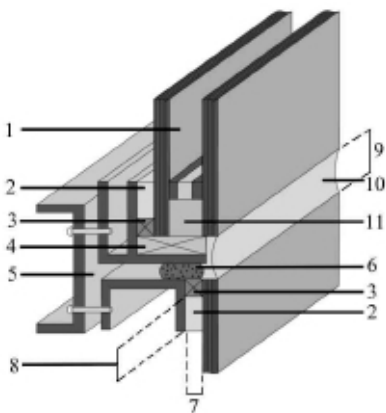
A: Détail d'une traverse. Exemples d'application: version deux côtés (assemblé sur site).
